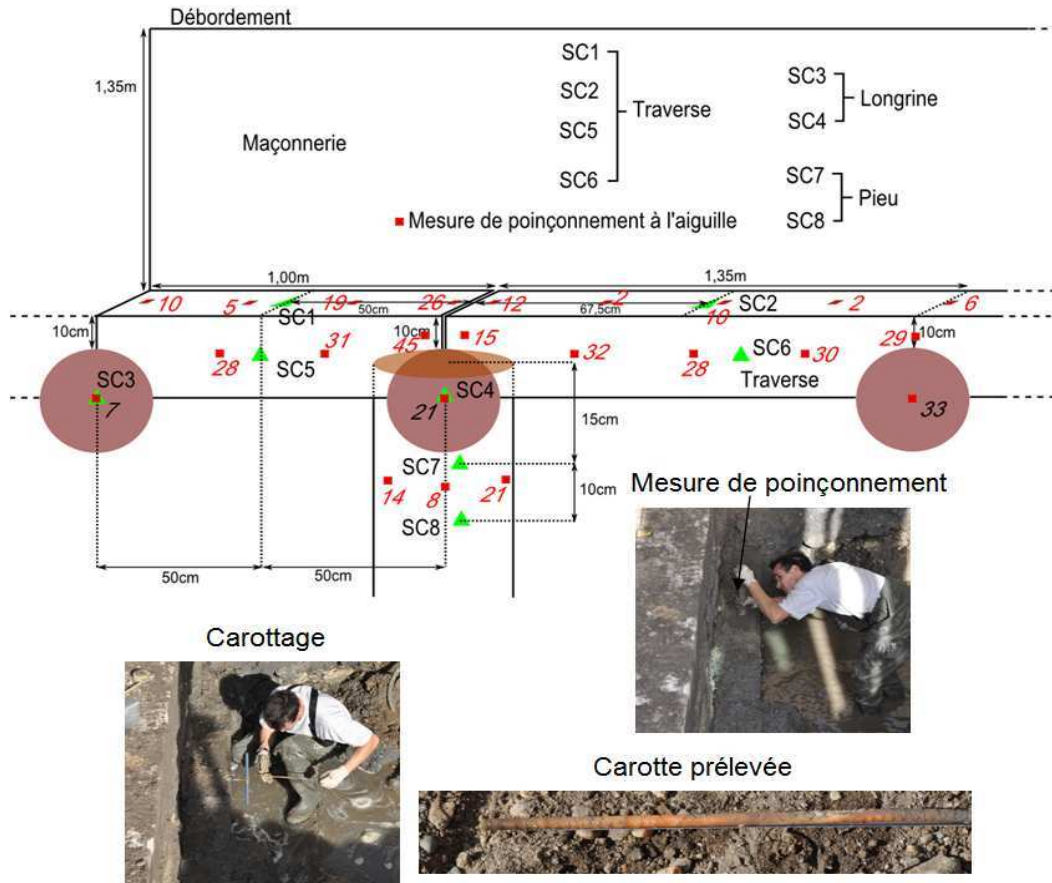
Plan d'implantation des tests de poinçonnement à l'aiguille et des prélèvements des carottes
